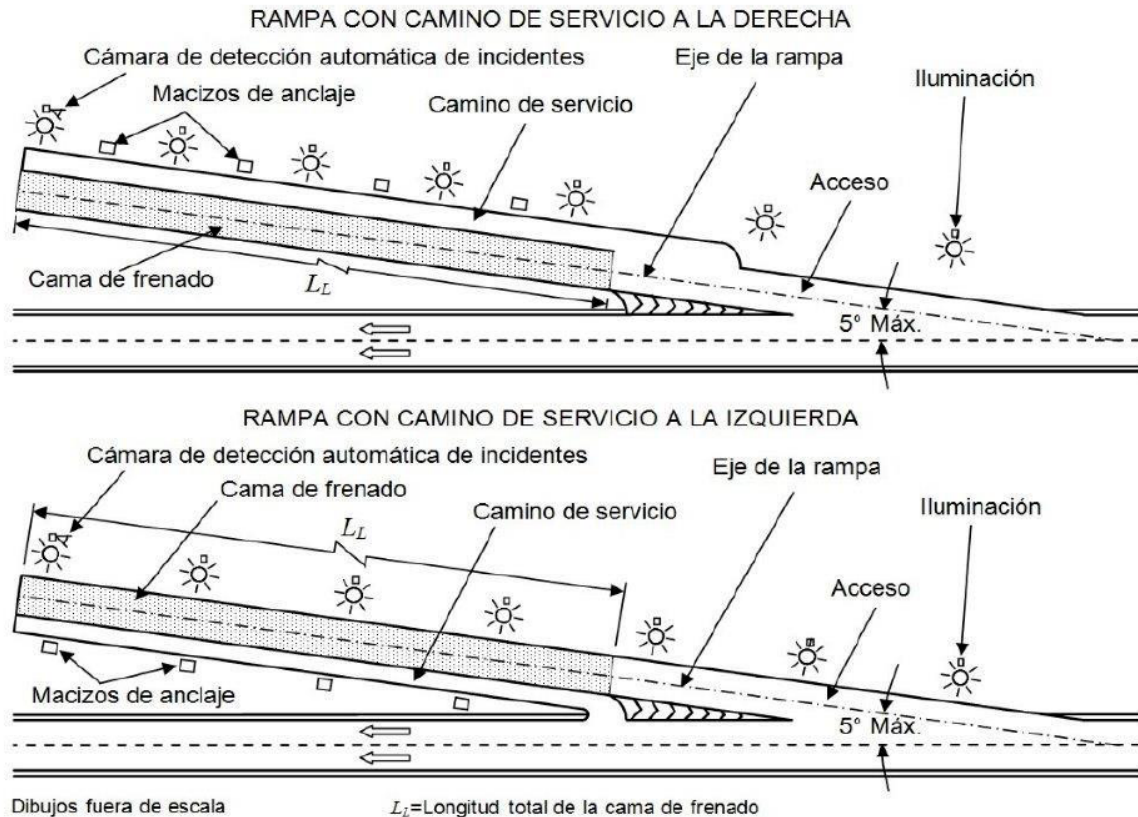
Rampa de emergencia para frenado. Esquema de disposición en planta
